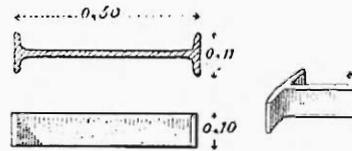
Élévation, coupe et perspective des *crampons en fer*, liant aux poutres les caissons du Parthénon.
